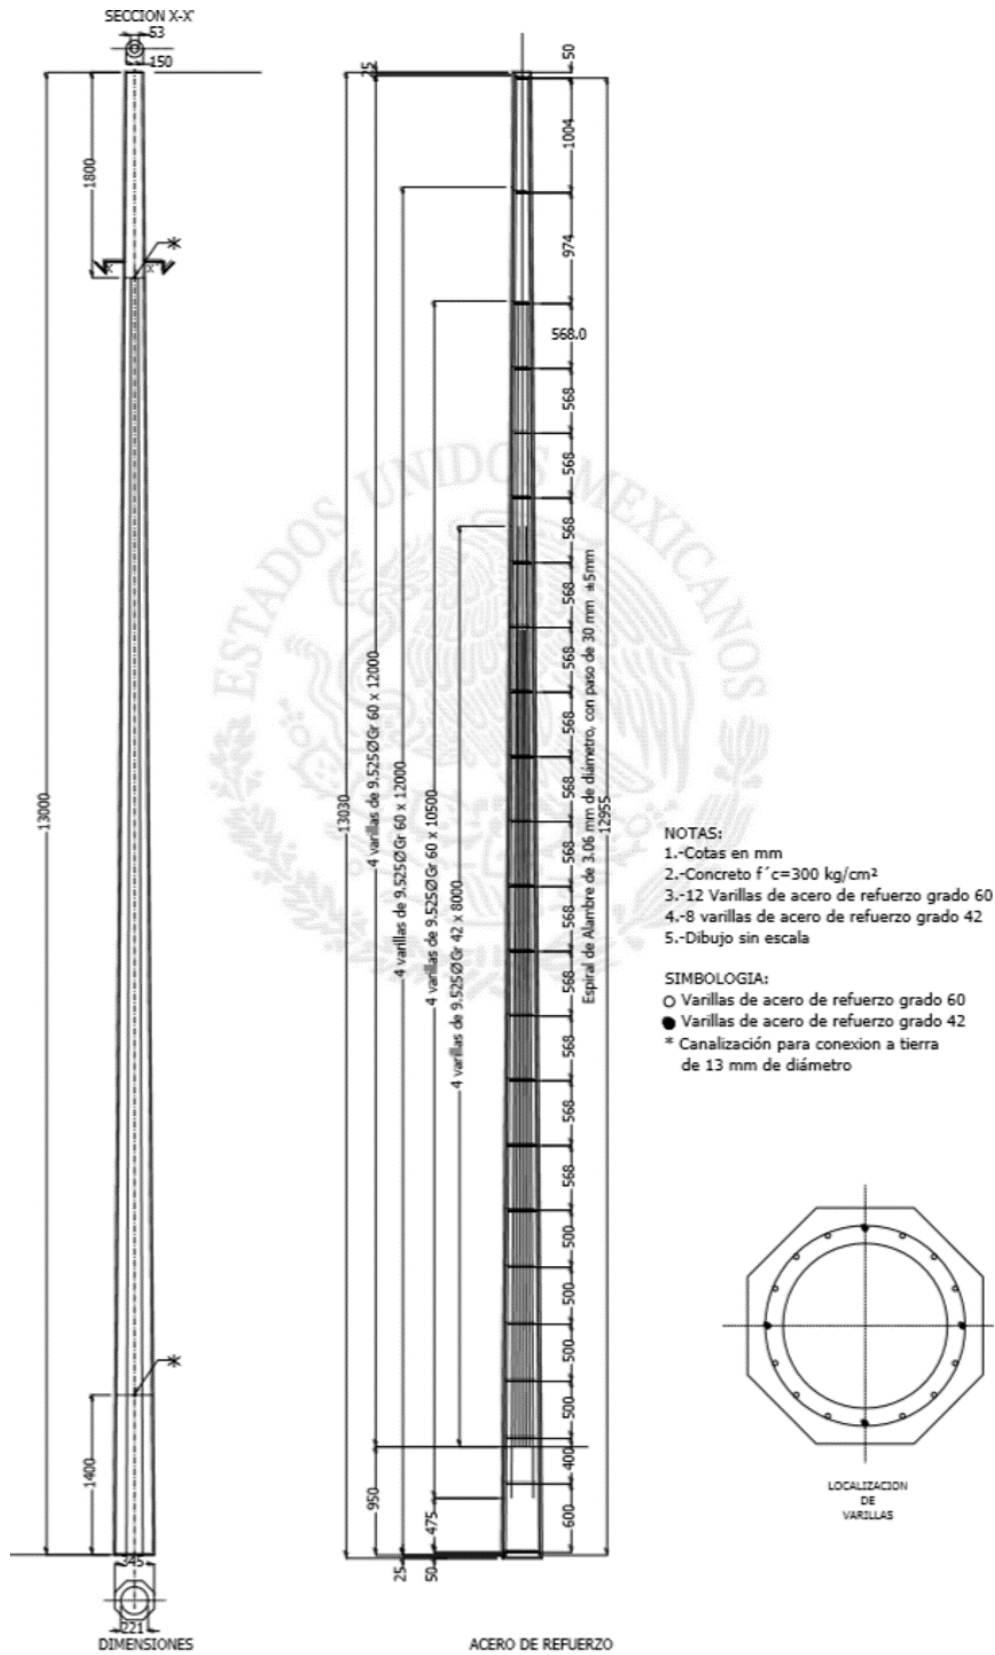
Planos de especificación para postes de concreto reforzado G60 PCR- 13-600 de 13 metros.
